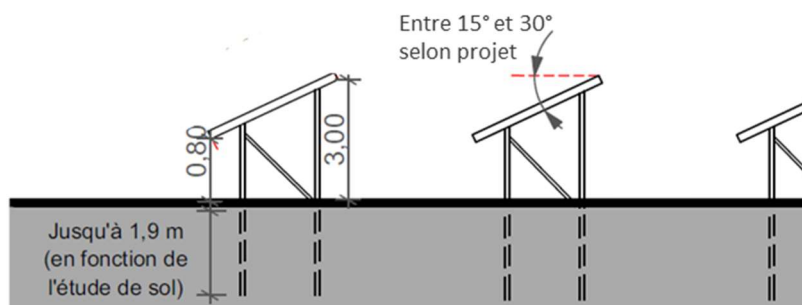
Plan en coupe de l'implantation (Source : EOLFI)
